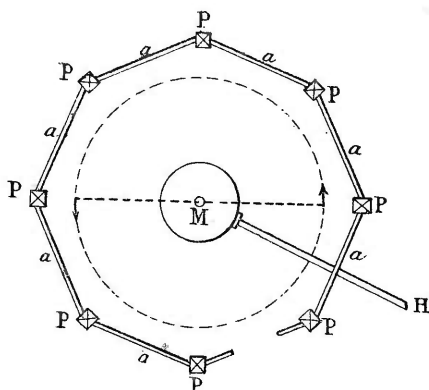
Plan d'un bâtiment spécial où est établi un manège.
